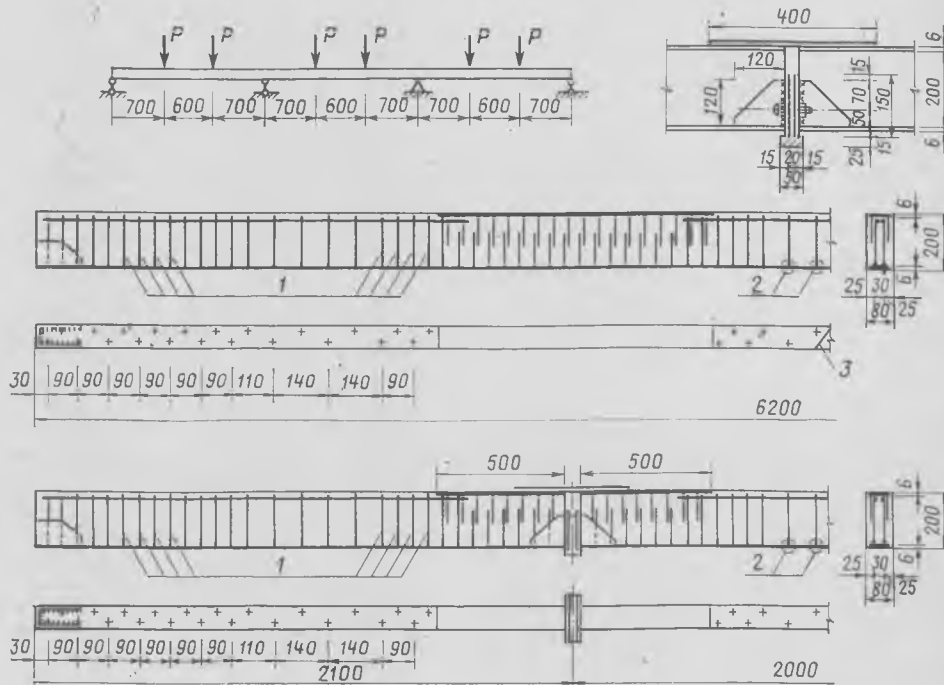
Конструкция неразрезных трехпролетных сталобетонных балок с внешним армированием и схема испытания
